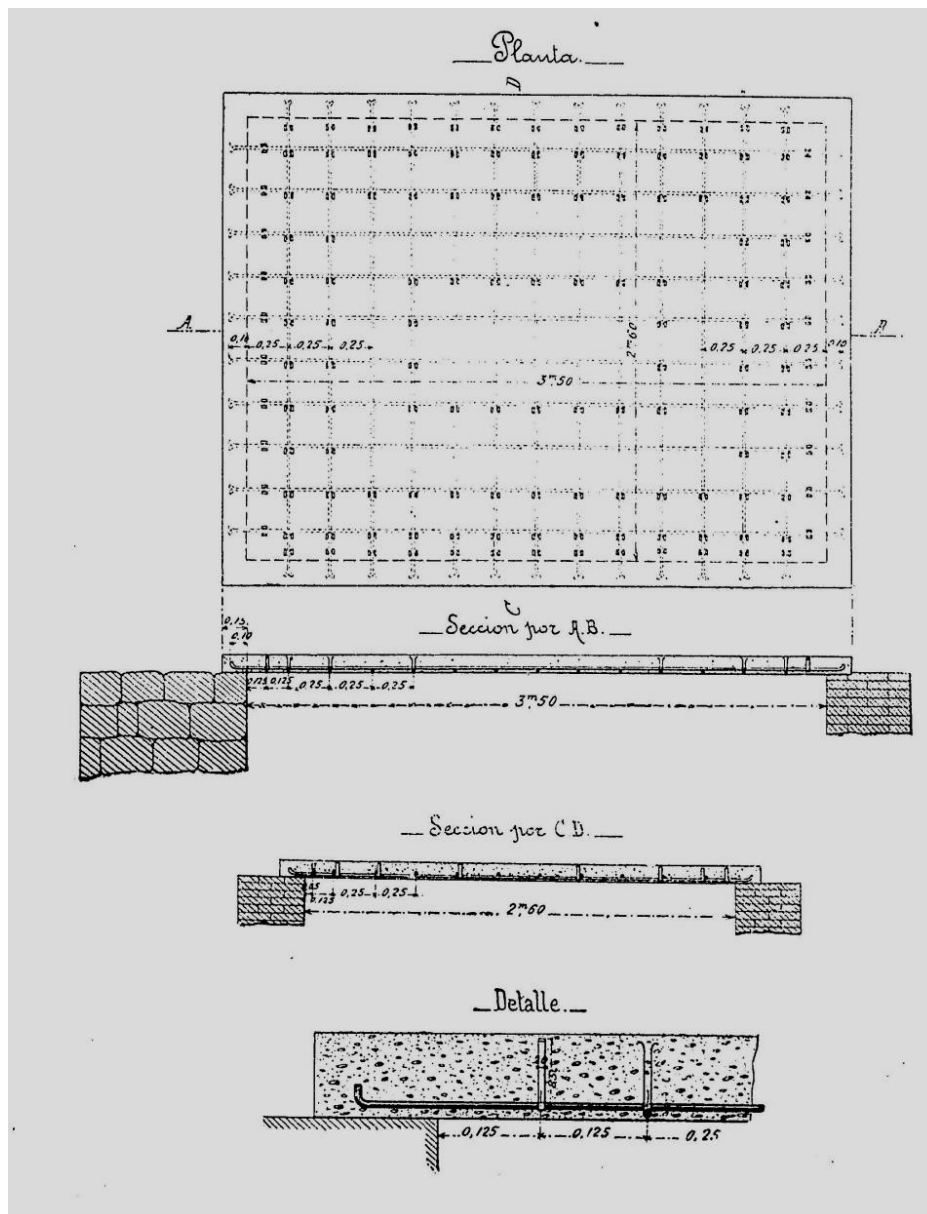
Planta y sección del piso de hormigón armado sistema Hennebique objeto de la prueba. Revista de Obras Públicas No.1.188 año 1898
